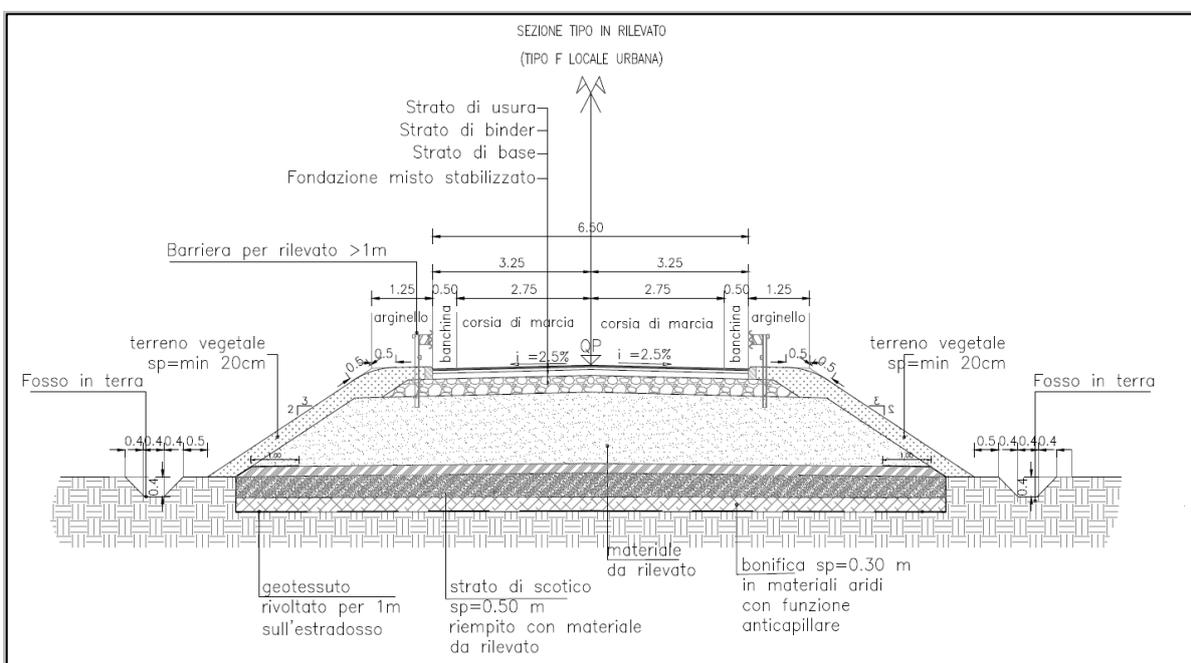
Sezione tipo in rilevato della viabilità da adeguare
